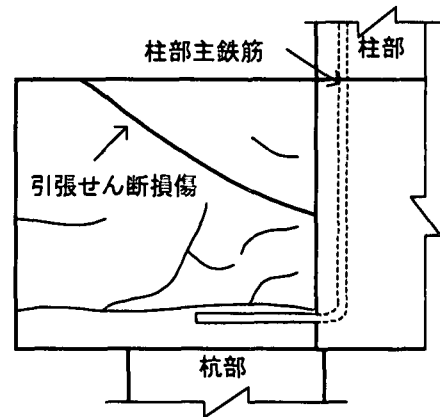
フーチング断面でのひび割れ状況 (No.4)
